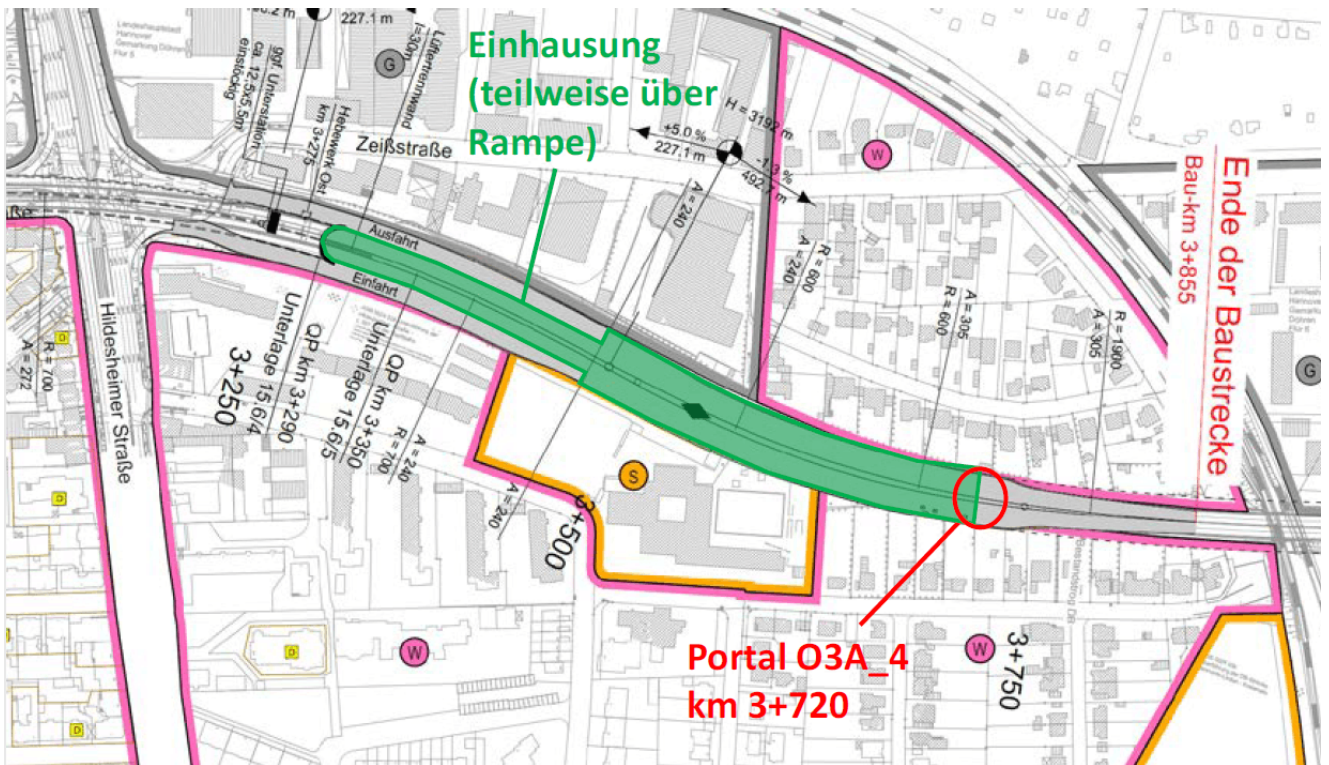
Lageplanskizze Planvariante O3A_4 [20].
